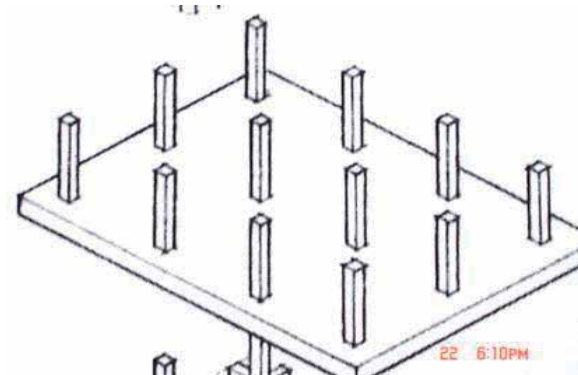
Fuente: "Diccionario Visual de Arquitectura" Pág.57
